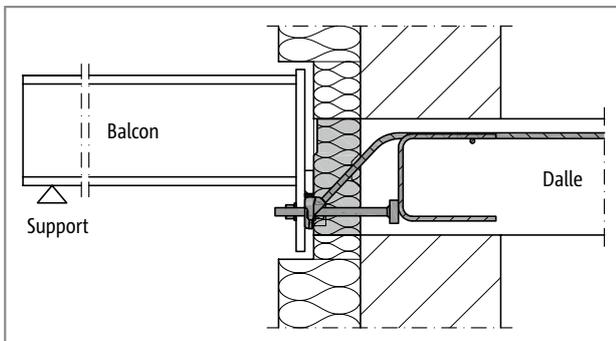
Schöck Isokorb® T type SQ : Transition sans obstacle grâce au décalage en hauteur
